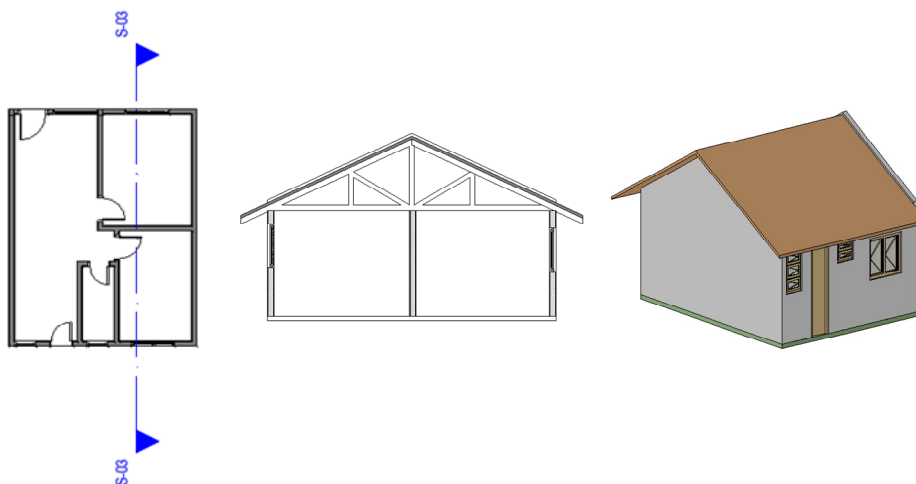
Casa modelo convencional em três vistas (planta baixa, corte e perspectiva)
